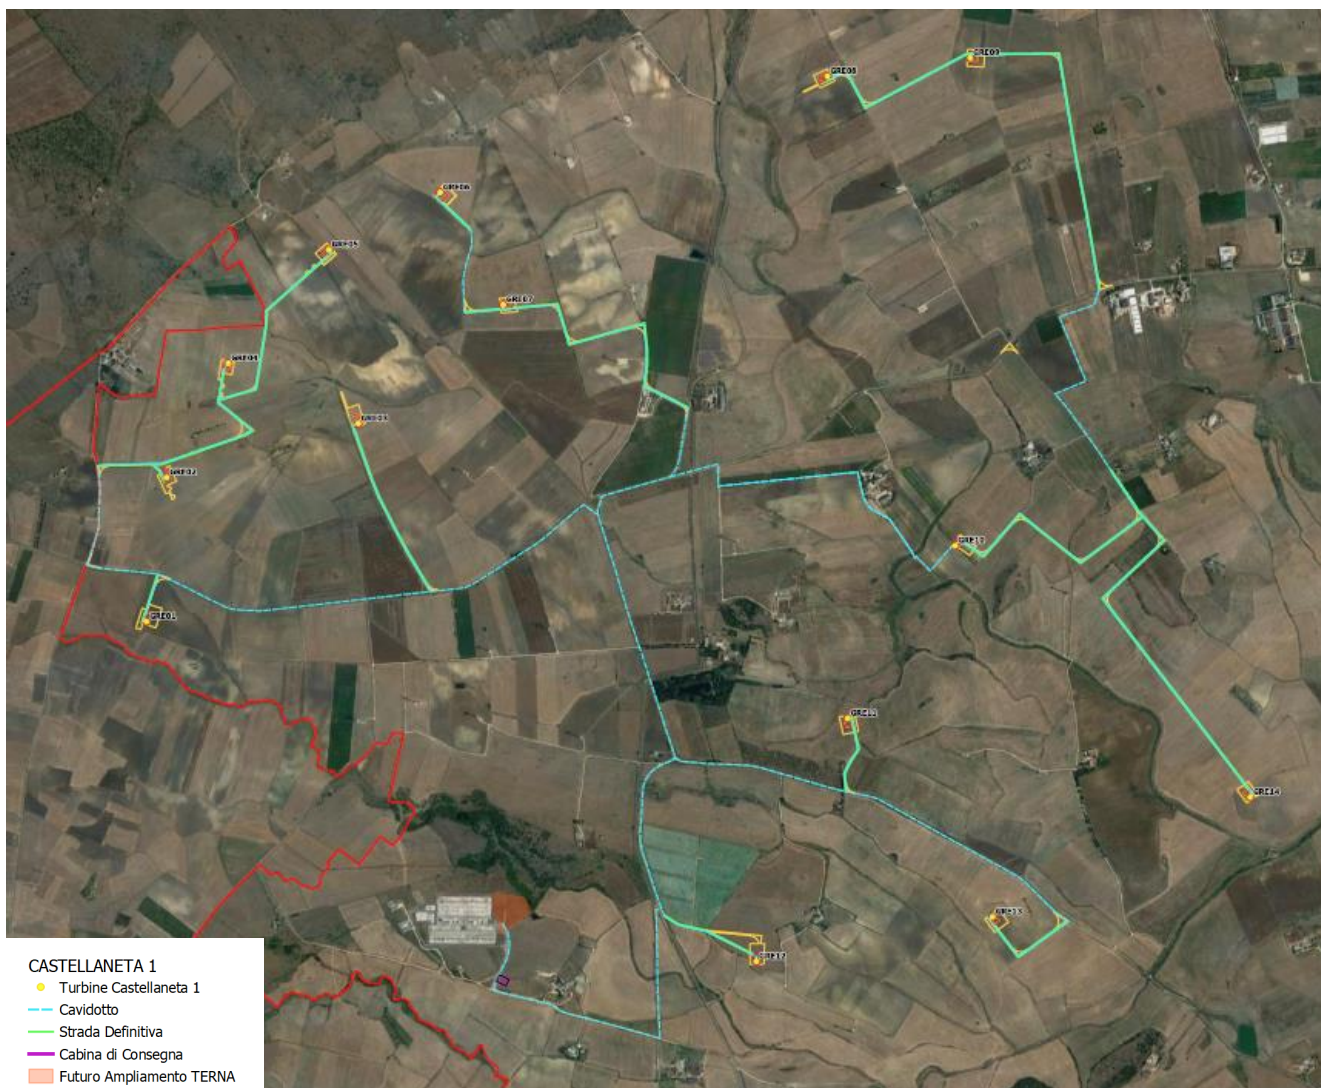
Area di intervento: dettaglio layout di progetto su ortofoto
